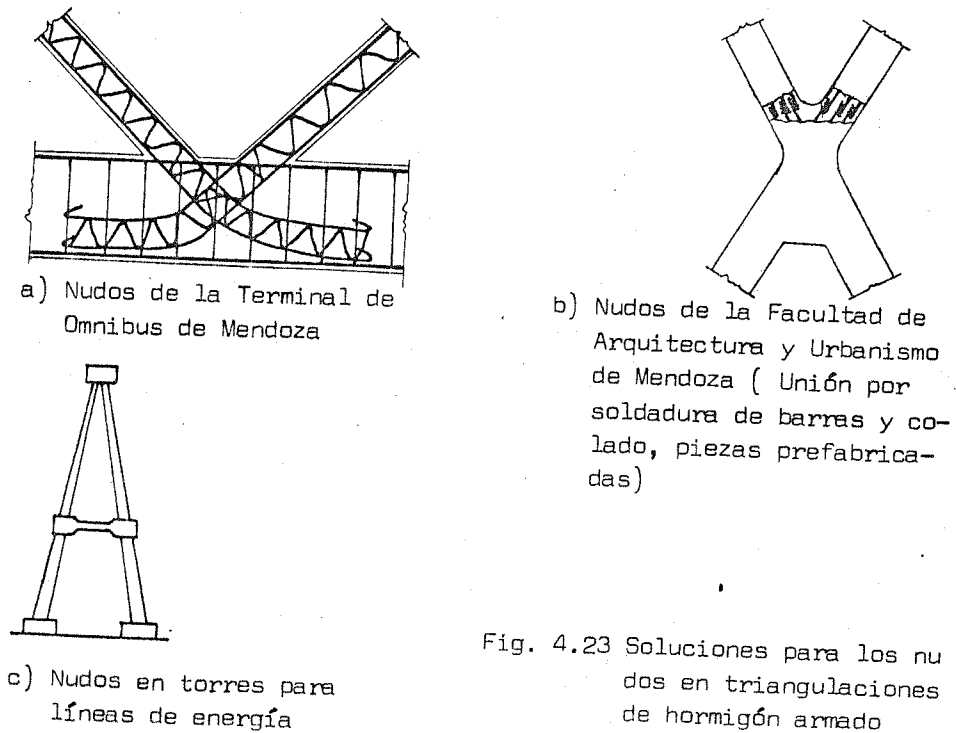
Soluciones para los nudos en triangulaciones de hormigón armado
